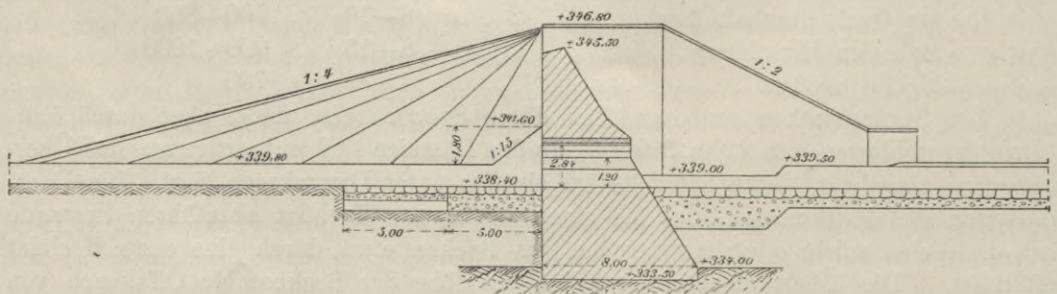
Schnitt durch den gemauerten Überfall im Staudamm des Stauweihers bei Herischdorf.
